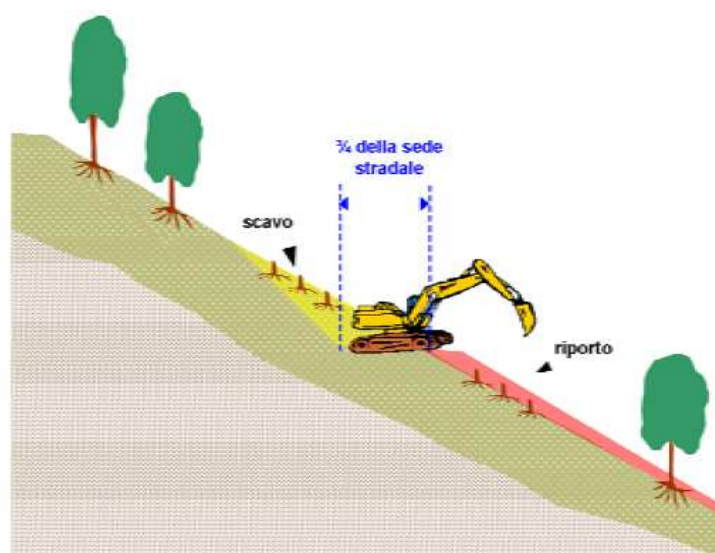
Schema di realizzazione pista di cantiere Tipo II - Riporto parziale.
